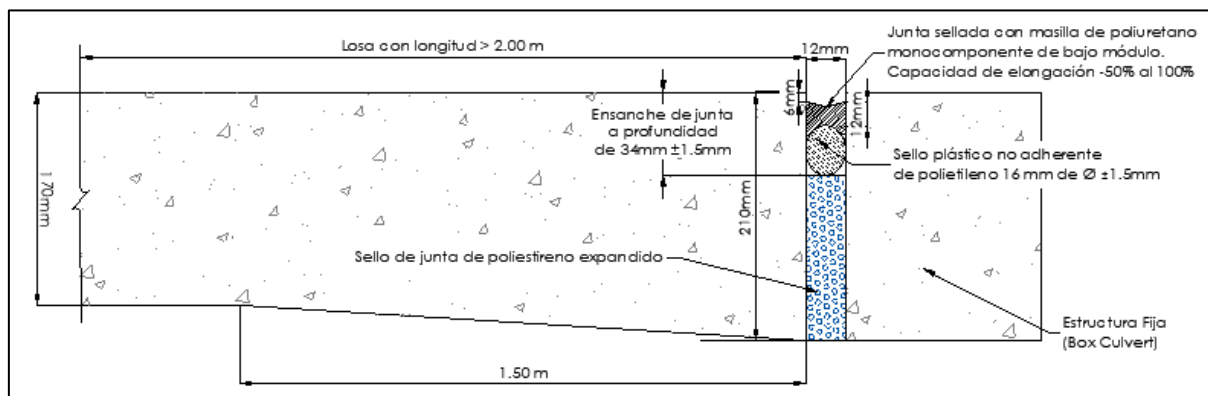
Detalle junta de aislamiento, losas con largo mayor a 2.00 m
